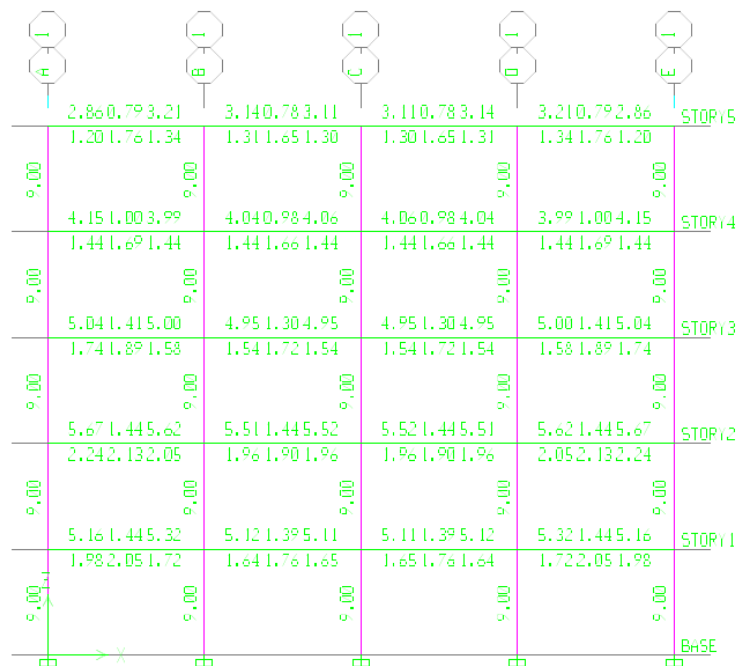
Área de acero en cm<sup>2</sup> para vigas y columnas P5 Caso4, Fuente ; El Autor
